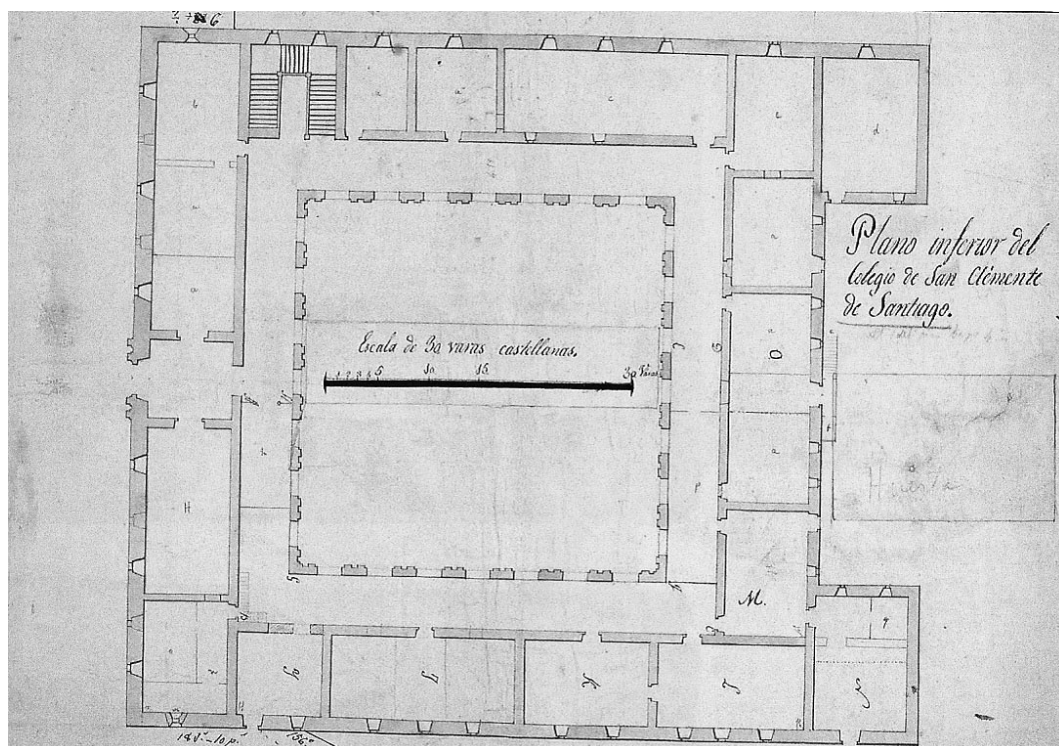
Plano de la planta original del colegio. AGMM. Fuente: Vigo Trasancos (2011).
